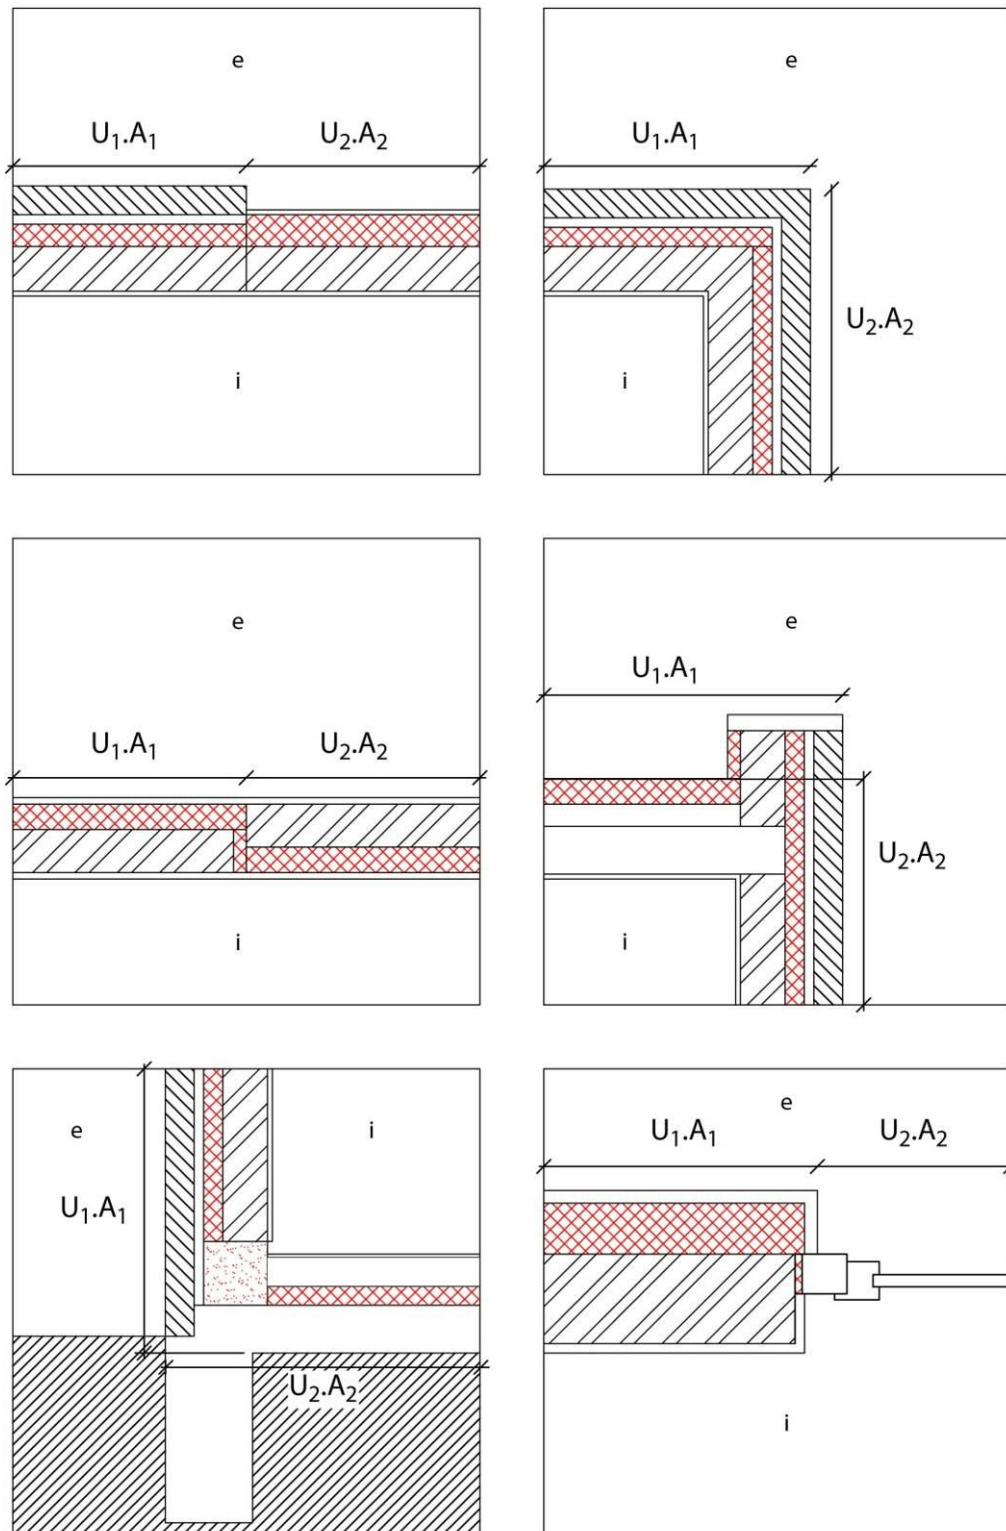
Exemples de nœuds constructifs linéaires au droit de la jonction de deux parois
